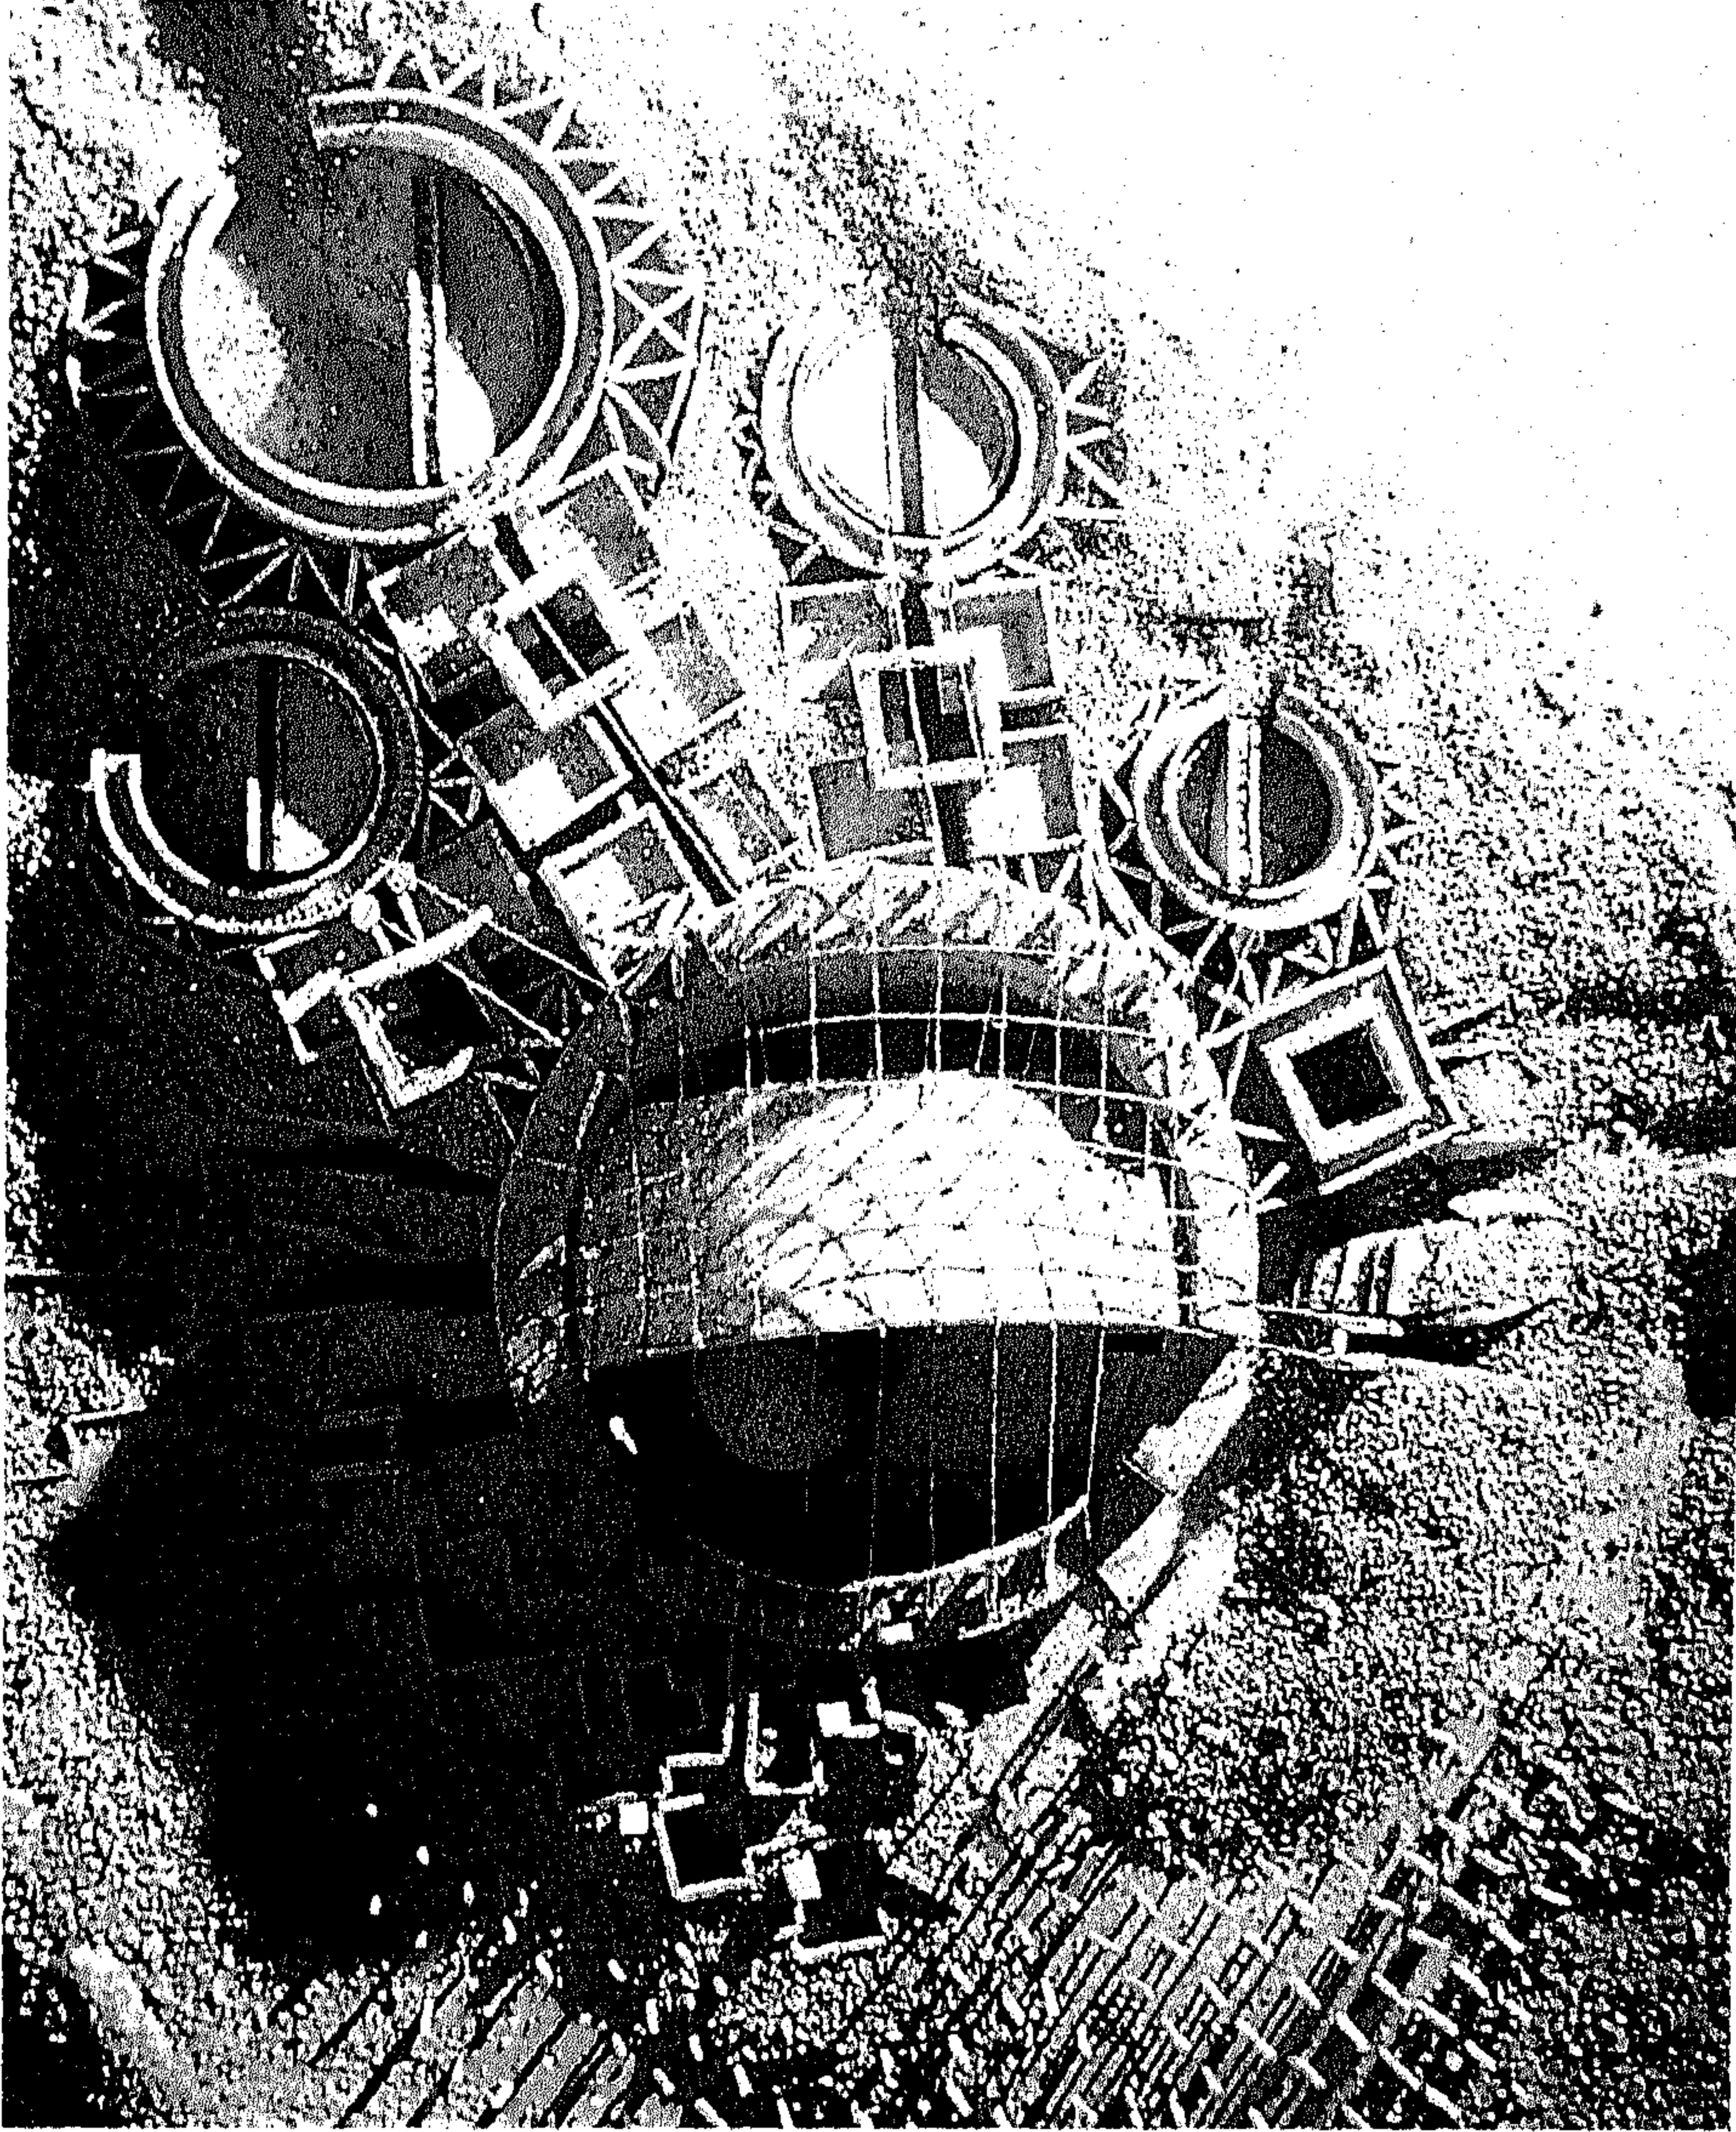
مسقط أفقي أكسونو متري
